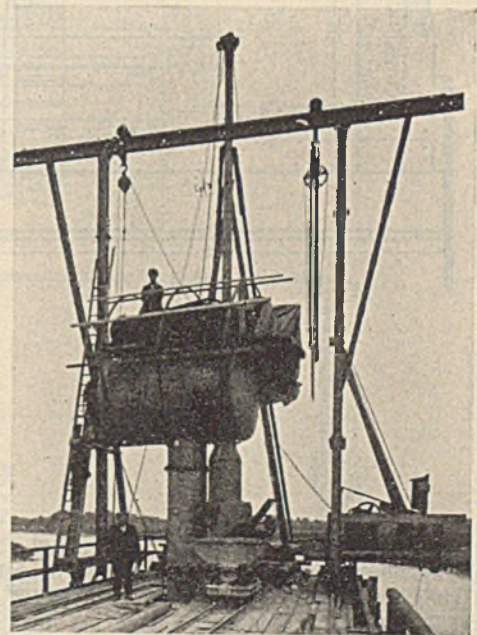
Plattform des Schüttgerüsts für Pfeiler II.
